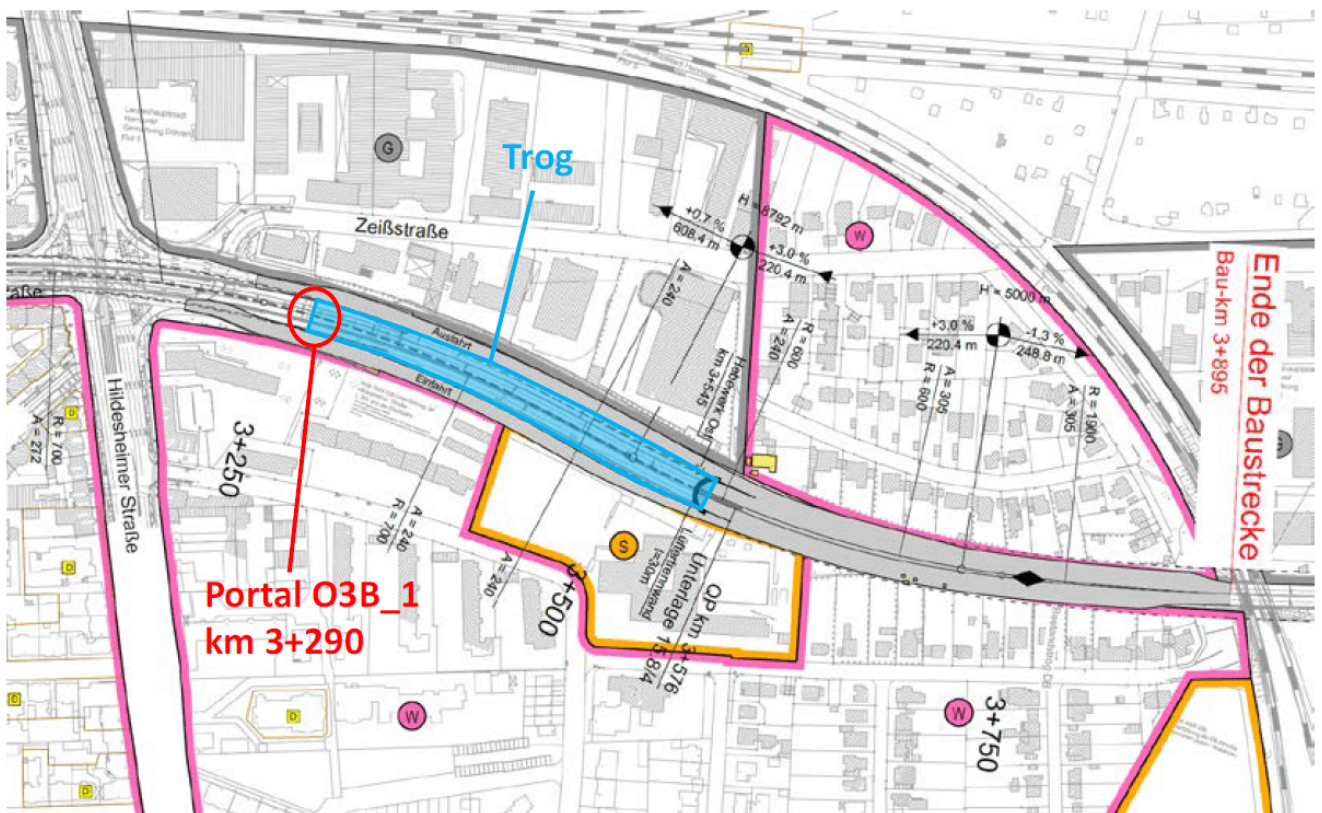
Lageplanskizze Planvariante O3B_1 [20].
